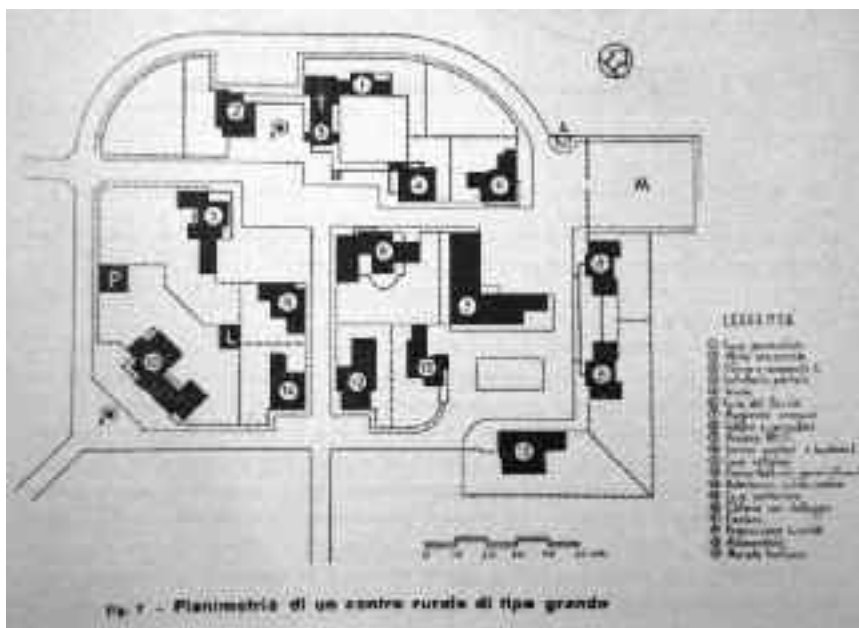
Centro rurale di tipo grande, Planimetria (Mangano, 1937).
